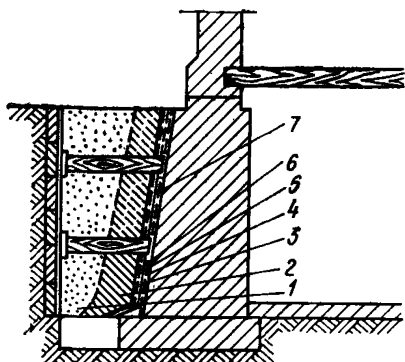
Устройство вертикальной гидроизоляции с наружной стороны фундамента
